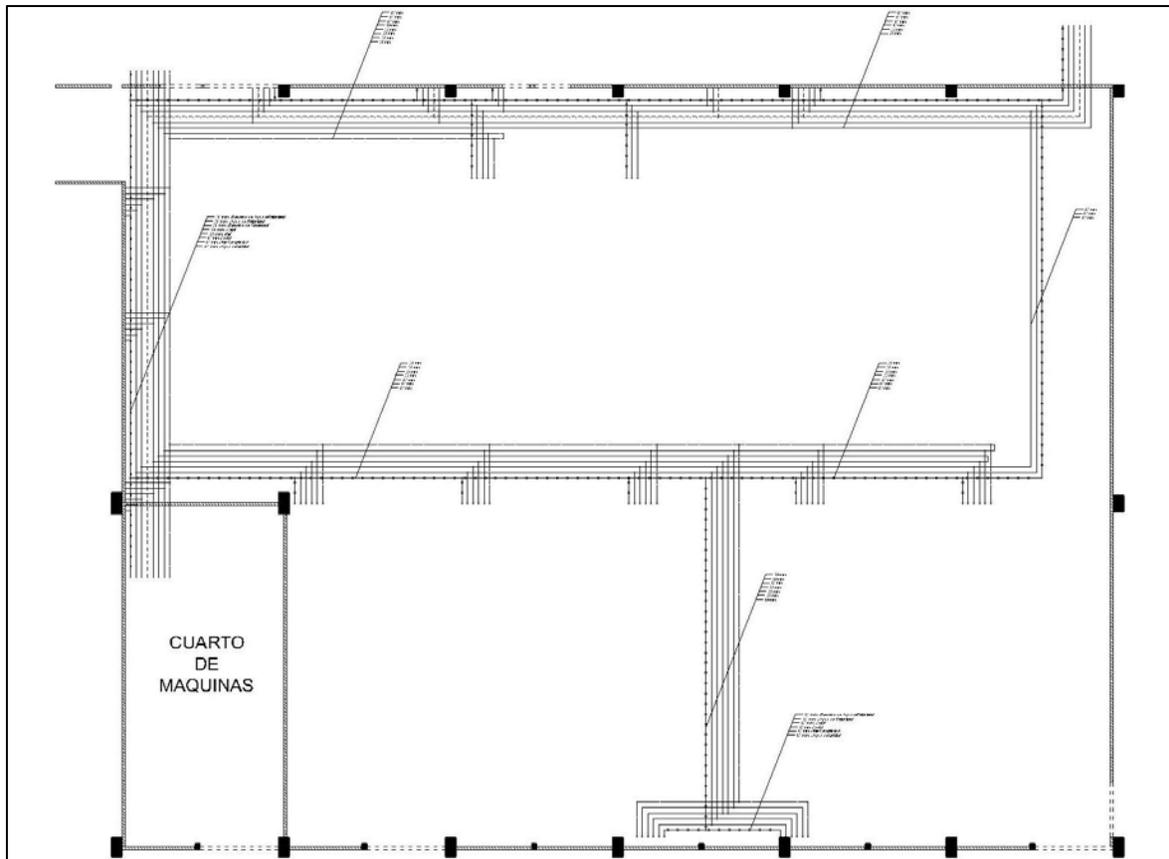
Plano de Tuberías en Planta Piloto FES Zaragoza (Modelo Monocromático).
